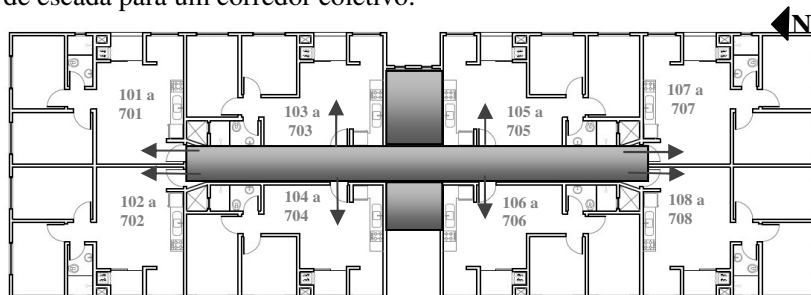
Planta baixa do pavimento tipo com demarcação das circulações.
